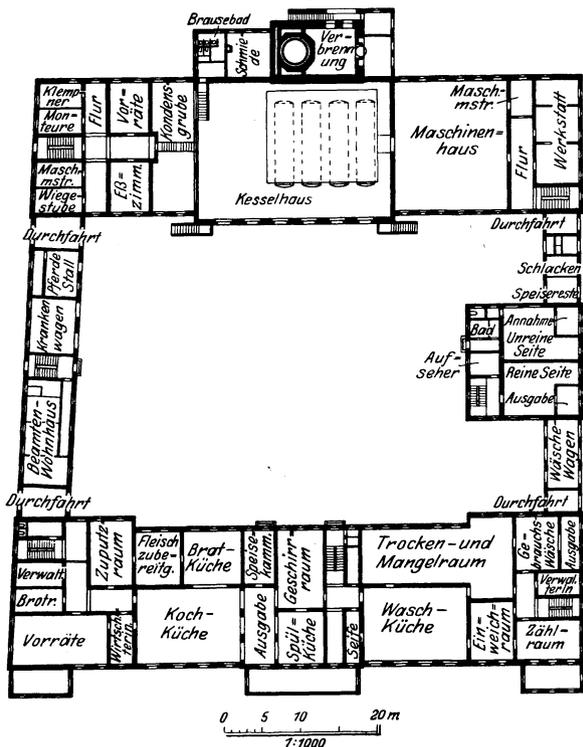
Berlin-Neukölln, städtisches Krankenhaus für 400 Betten. Wirtschaftsgebäude. (Maßstab: 1:1000 statt wie sonst 1:500.)
